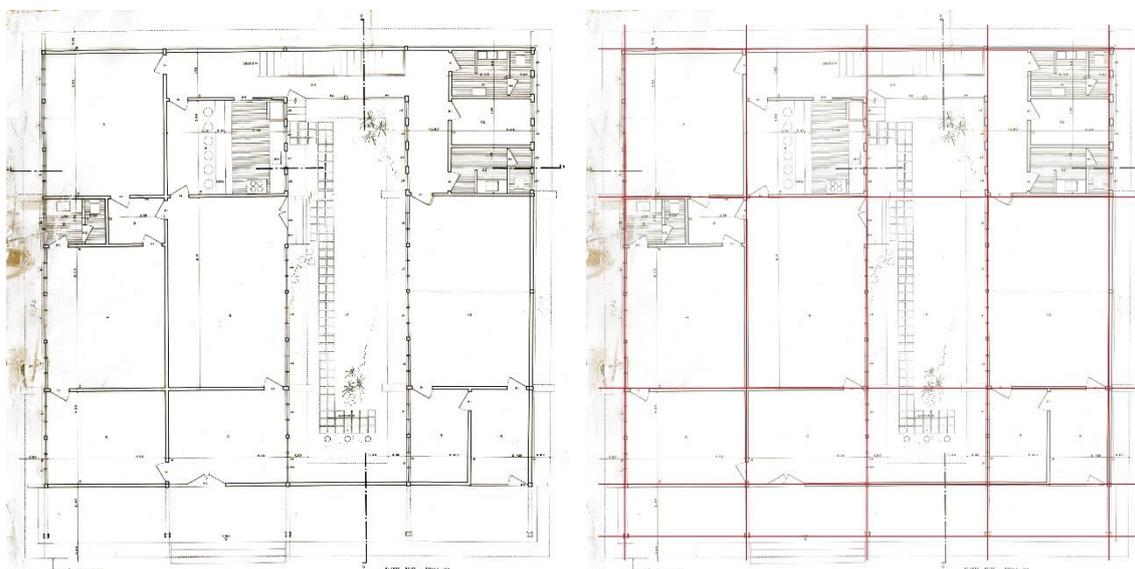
Planta-baixa pavimento principal e planta com indicação de modulação estrutural.
